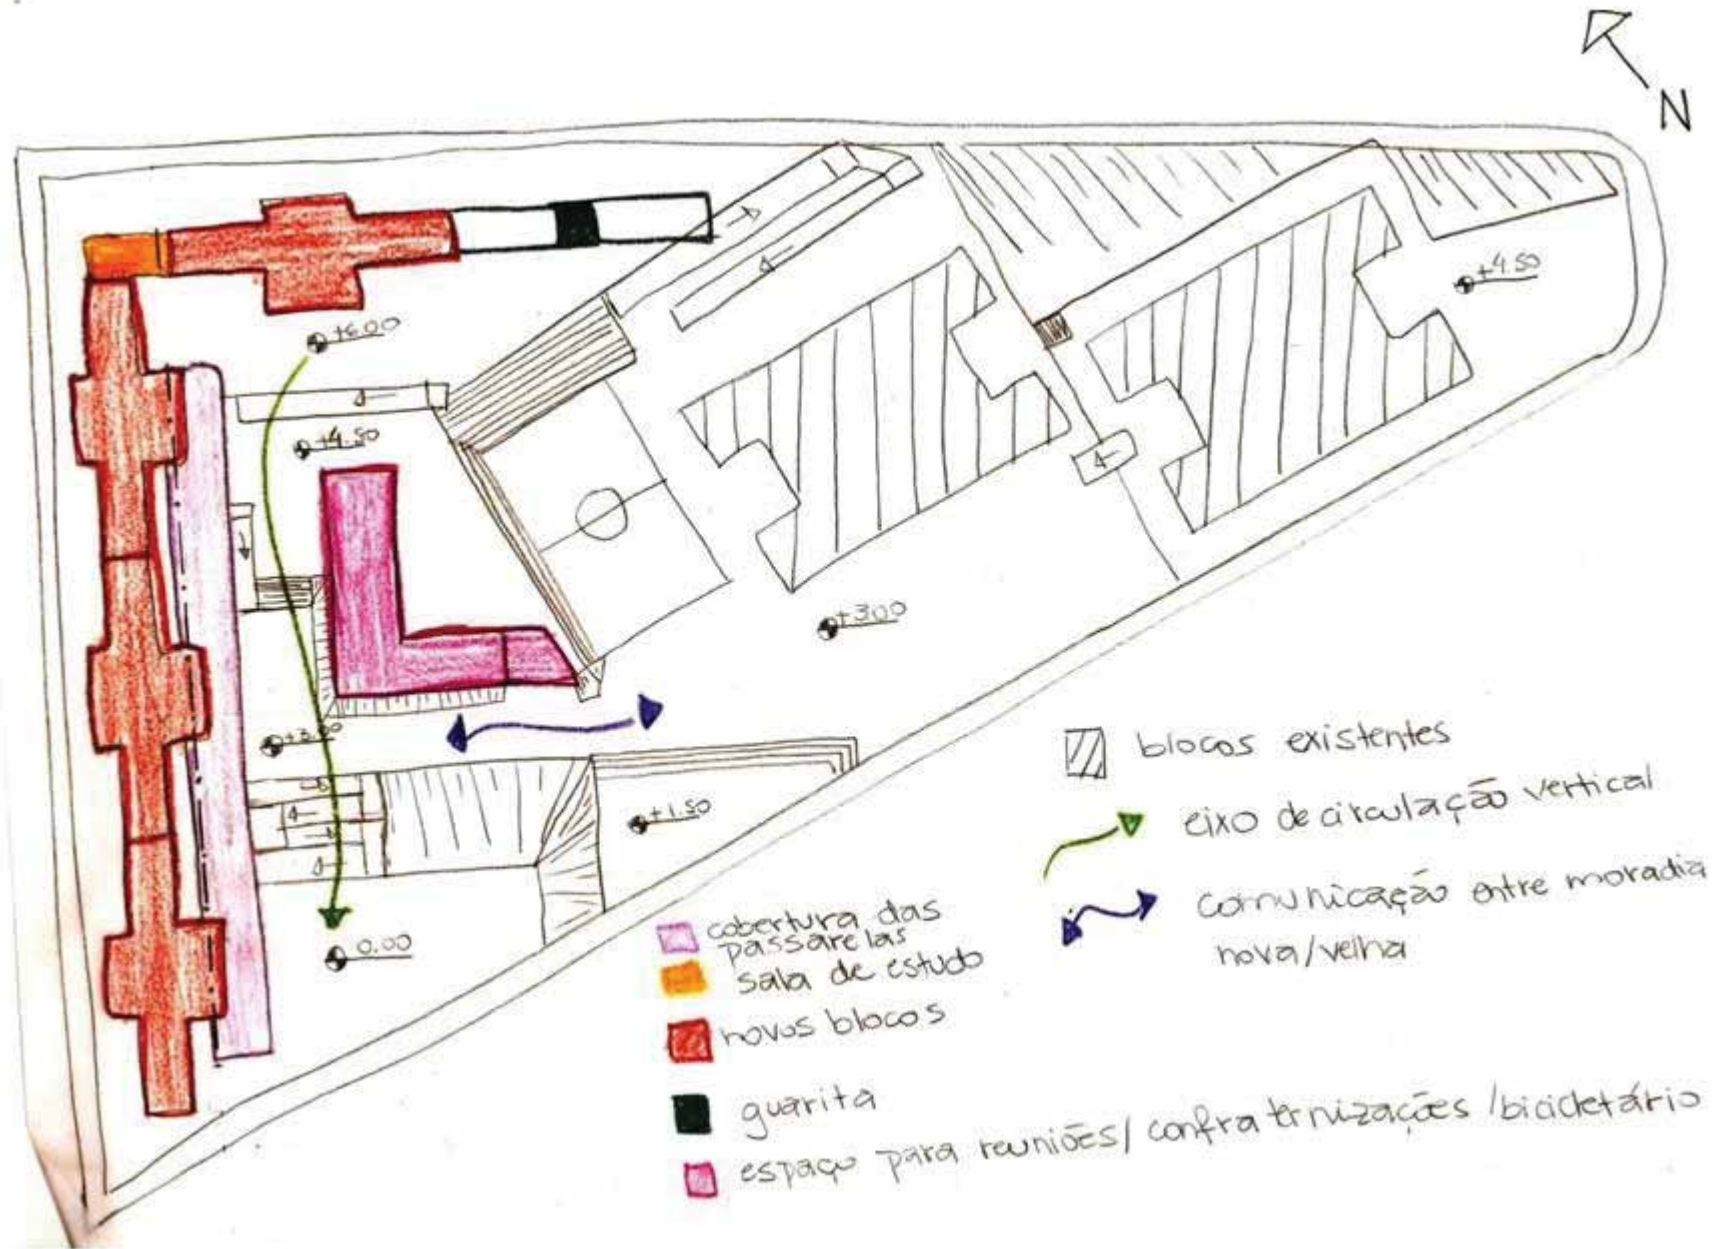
Croqui da segunda proposta de implantação com plano de massas. Fonte: FERRO, 2011.
